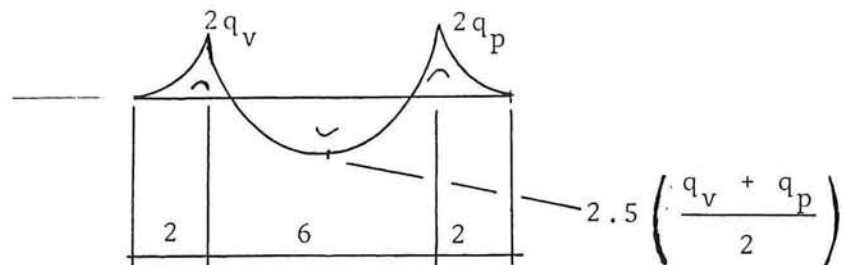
Palenplan onder platform, Momentverloop in doorsnede A-A
